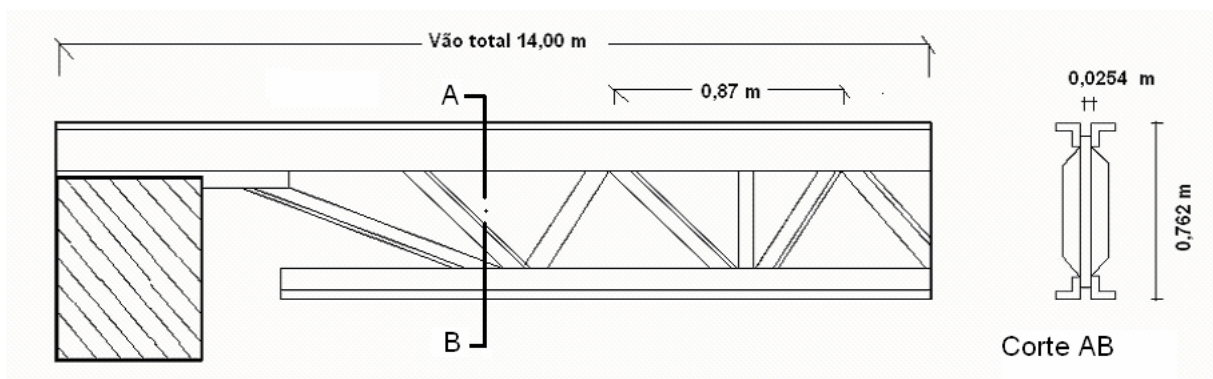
Esquema do dimensionamento das vigas treliçadas (joists) 30K8 [67]
